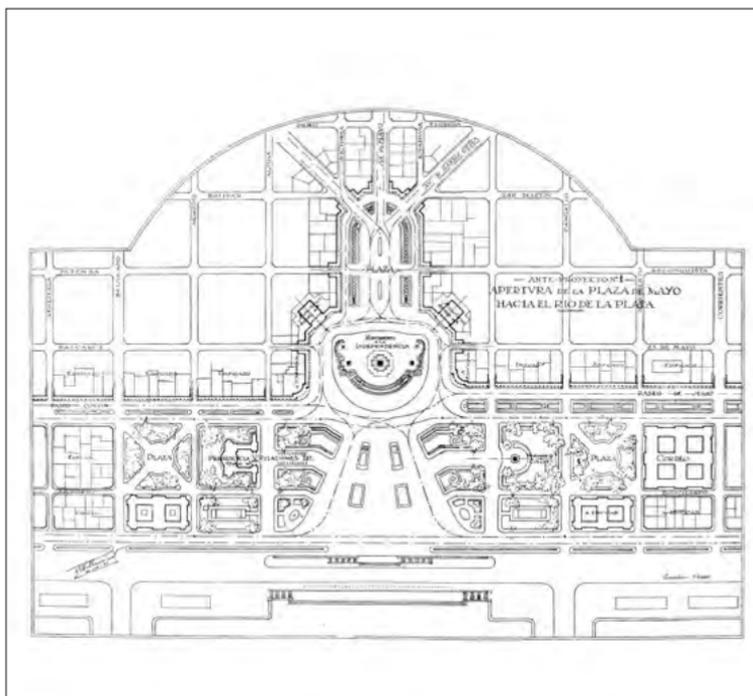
Planta de variante del proyecto de la Plaza de Mayo (CEE).
